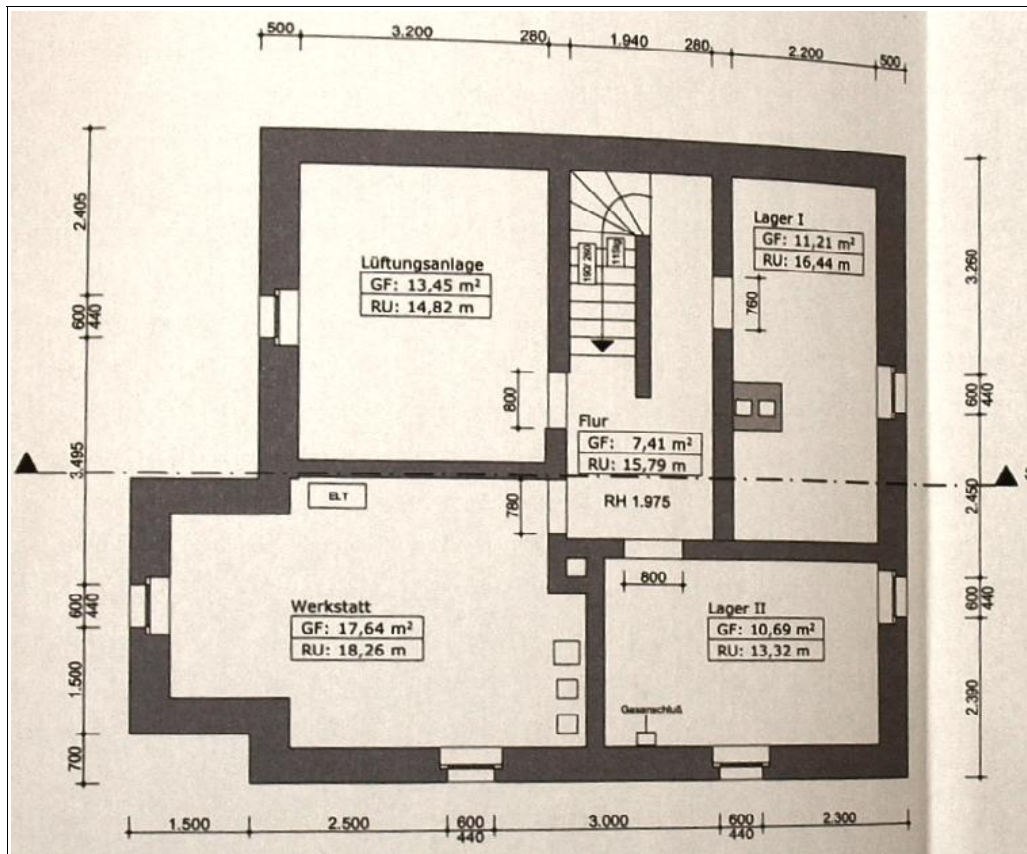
Grundriss Kellergeschoss (EFH)
